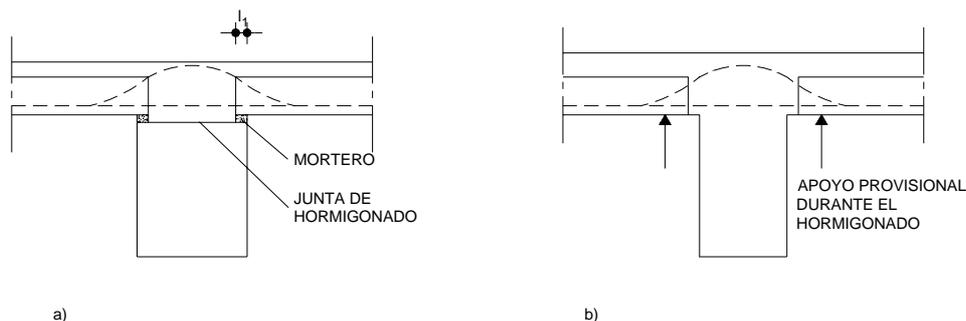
a) y b) Apoyos indirectos de losas alveolares: b) sin apuntalado de la losa alveolar pretensada, c) con apuntalado de la losa alveolar pretensada
